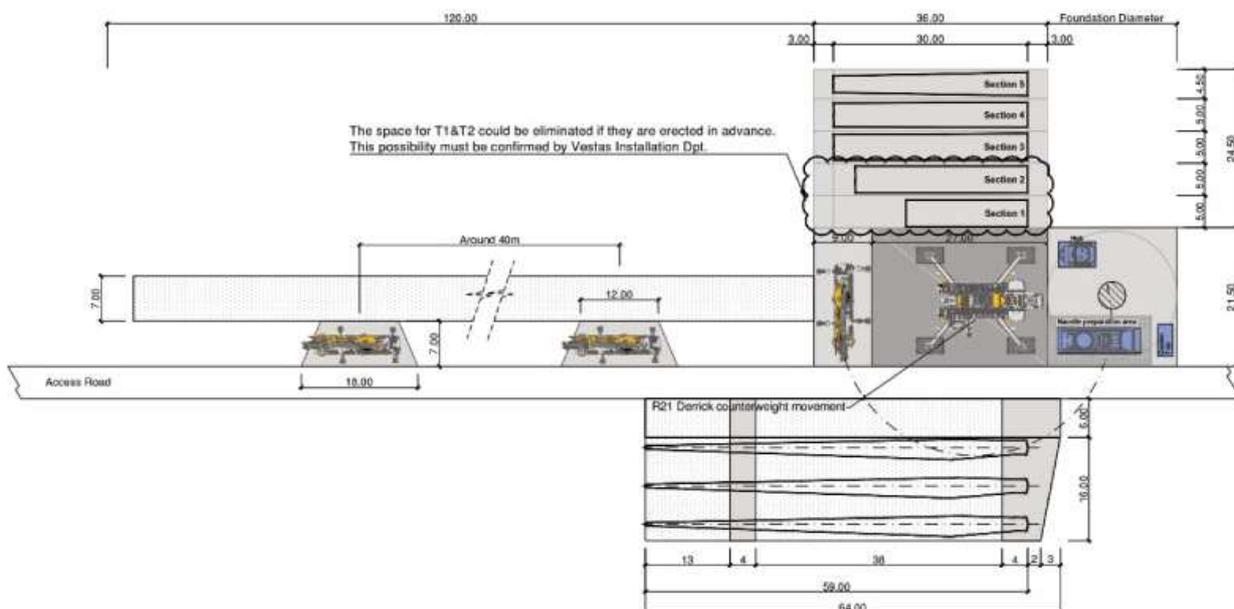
Schema di piazzola, vie di accesso e posizionamento gru
